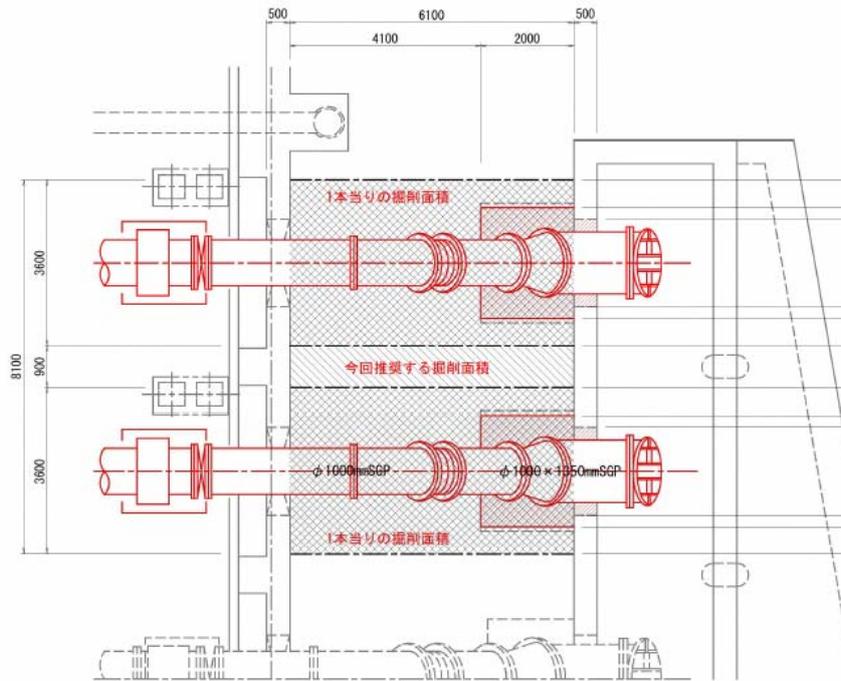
掘削平面図 (参考図 : φ1000 のとき)
